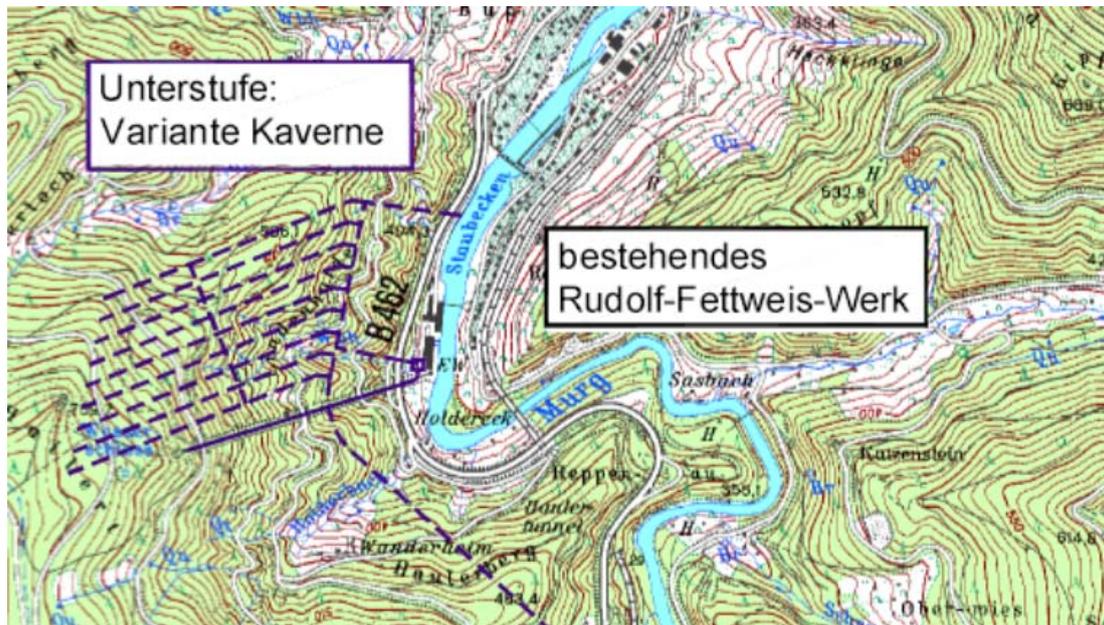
Lageplan Unterstufe mit unterirdischer Speichererweiterung
